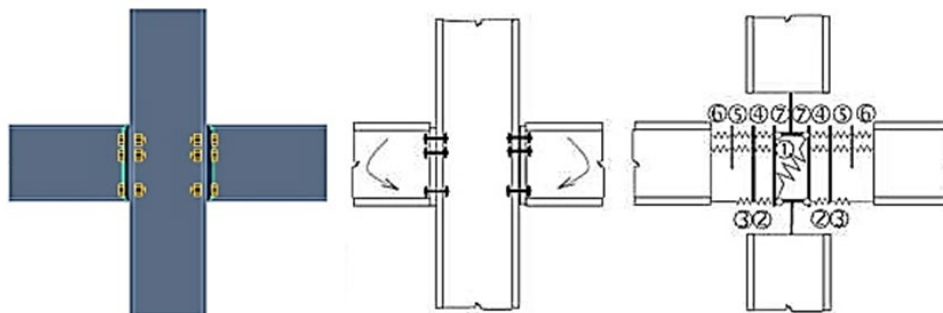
Компонентная модель узла: 1 – стенка колонны, работающая на срез; 2 – стенка колонны, работающая на сжатие; 3 – полка и стенка балки, работающие на сжатие; 4 – полка колонны, работающая на изгиб; 5 – болты, воспринимающие растяжение; 6 – фланец, воспринимающий изгиб; 7 – стенка колонны, работающая на растяжение.
